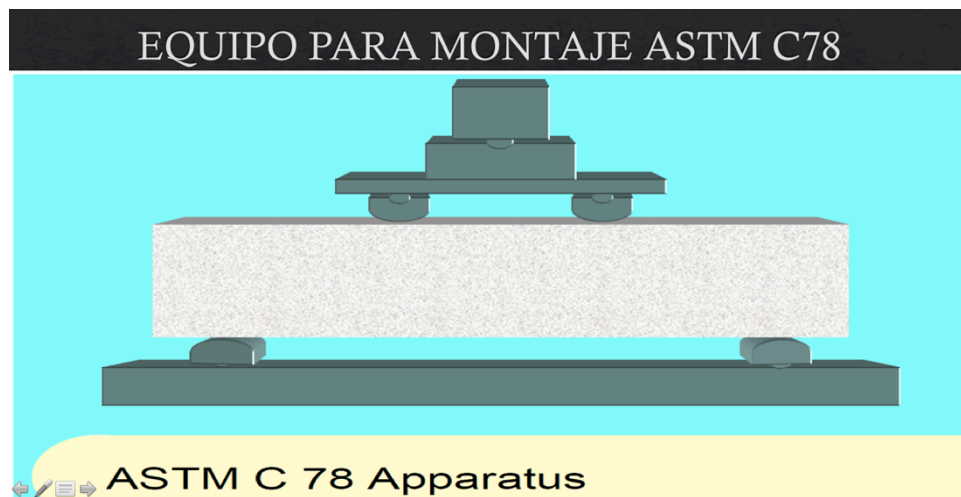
Esquema equipo de montaje ASTM C78 con viga de concreto.<sup>44</sup>
